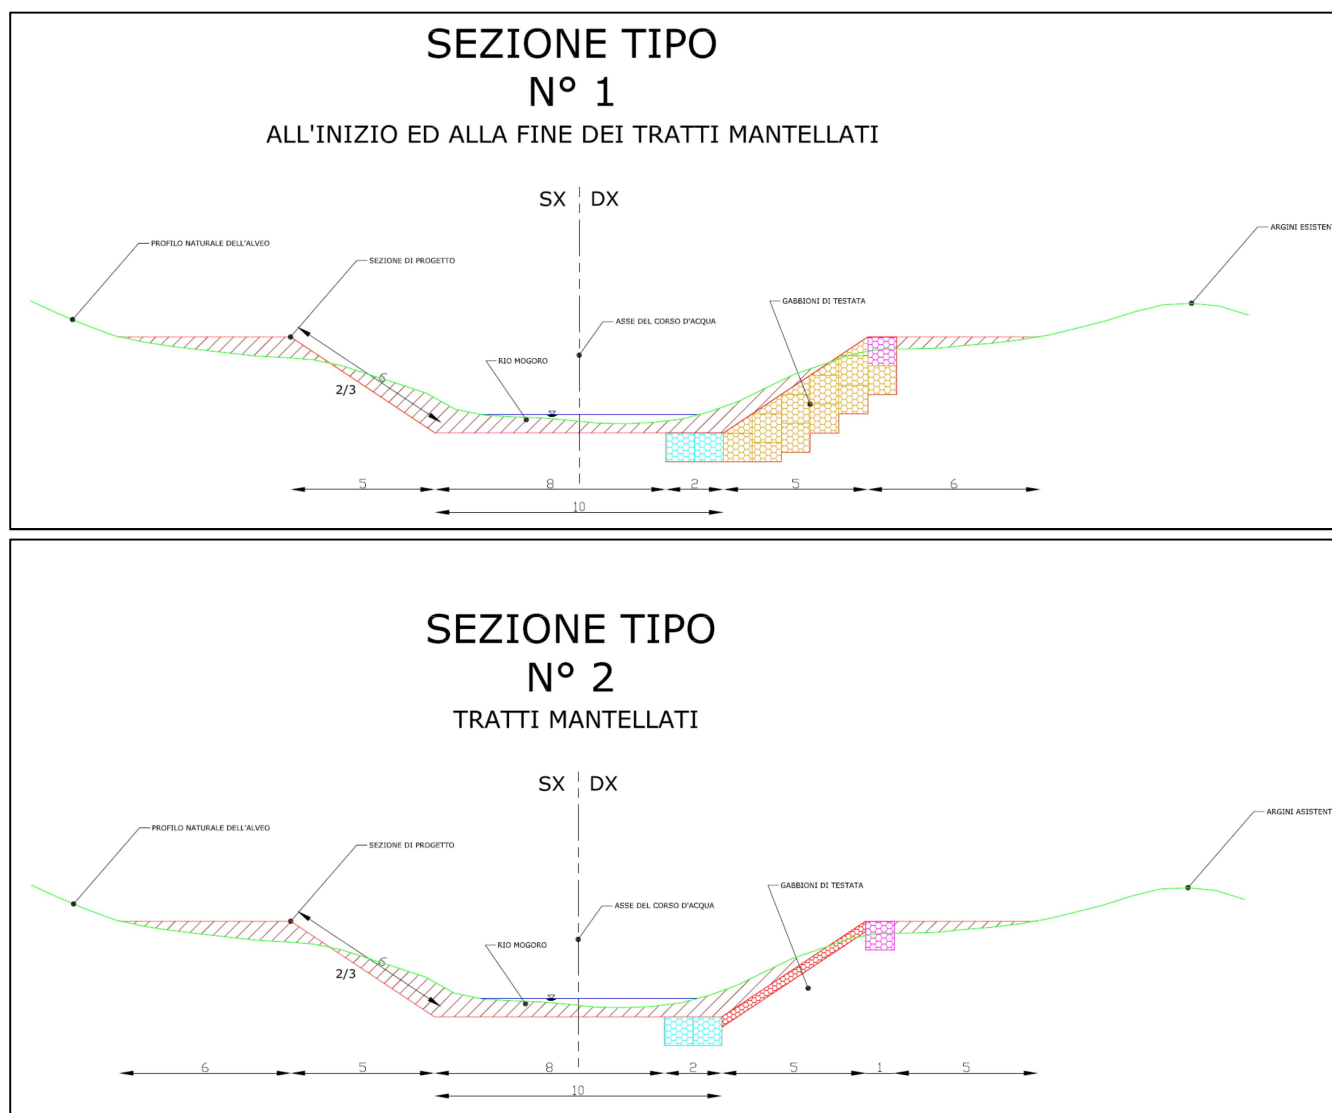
sezione tipo degli interventi previsti di rimodellamento di sponde e alveo del Rio
